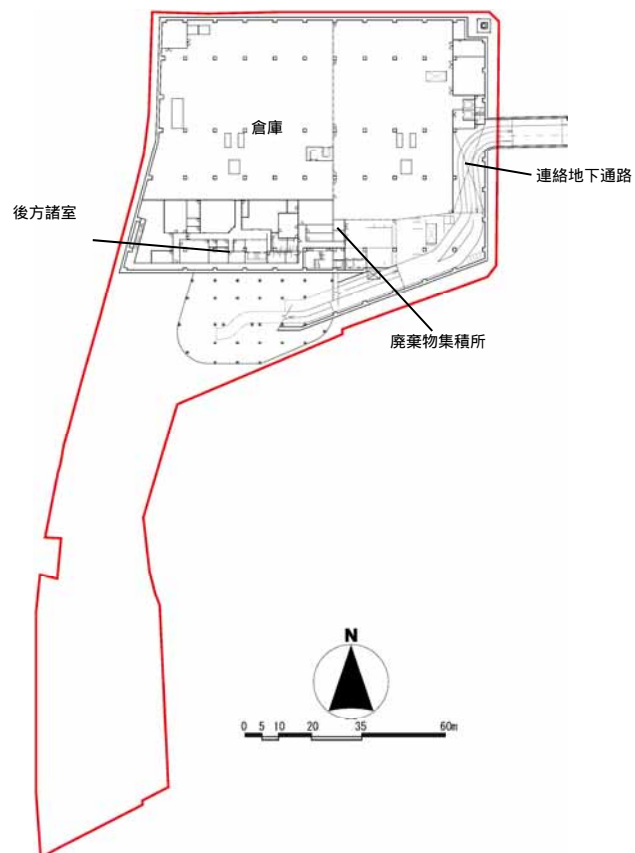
(2) 各階平面図（地下1F）（変更前：評価書）
